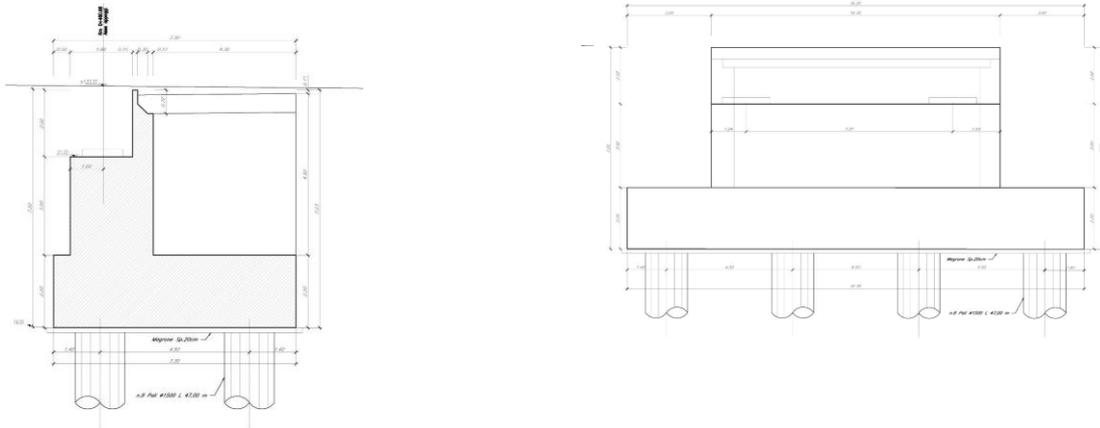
Sezione longitudinale spalla (sinistra) e Sezione trasversale della spalla (destra)
